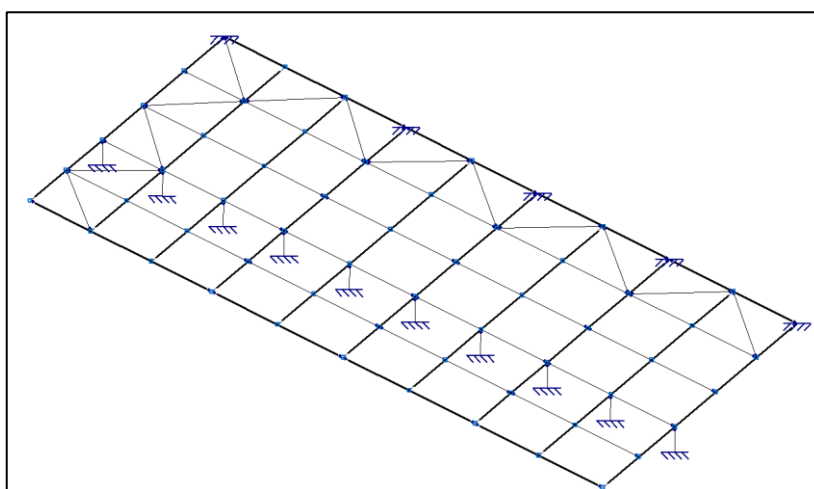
Modelo de barras da cobertura em perfis dobrados – alternativa em concreto.
